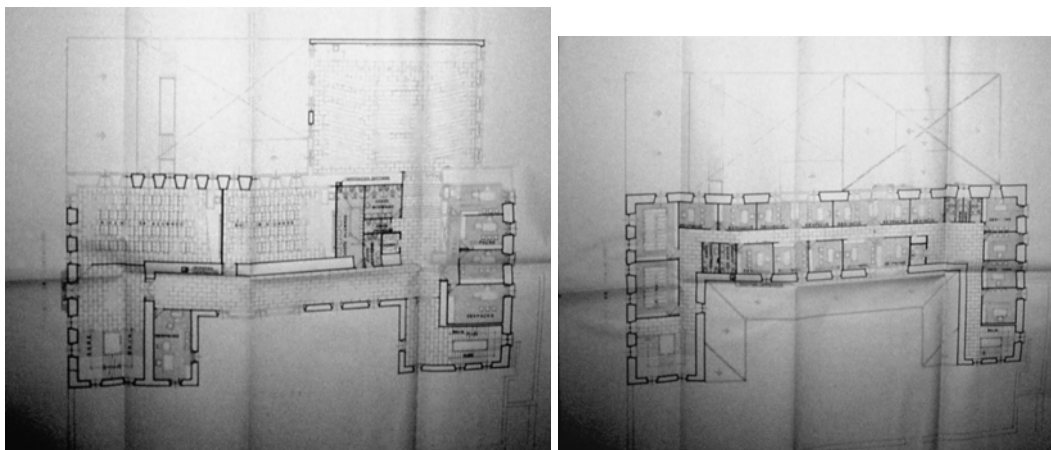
Facultad de Matemáticas: planta baja, por Antonio García Lozano, octubre de 1977.
